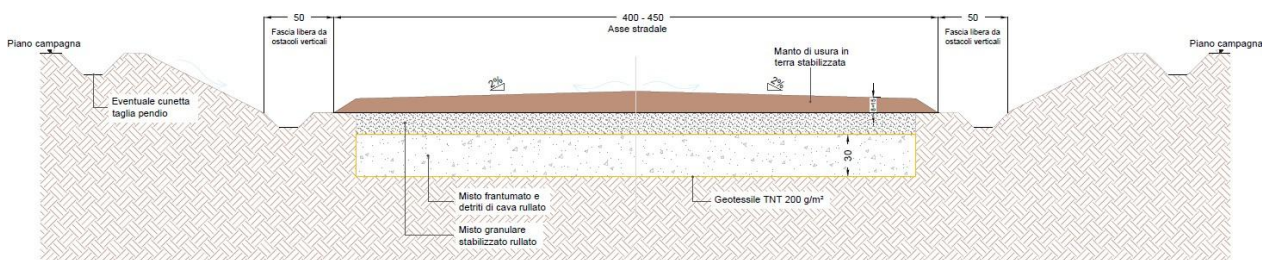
Sezione tipo pista di impianto in trincea; misure in centimetri
